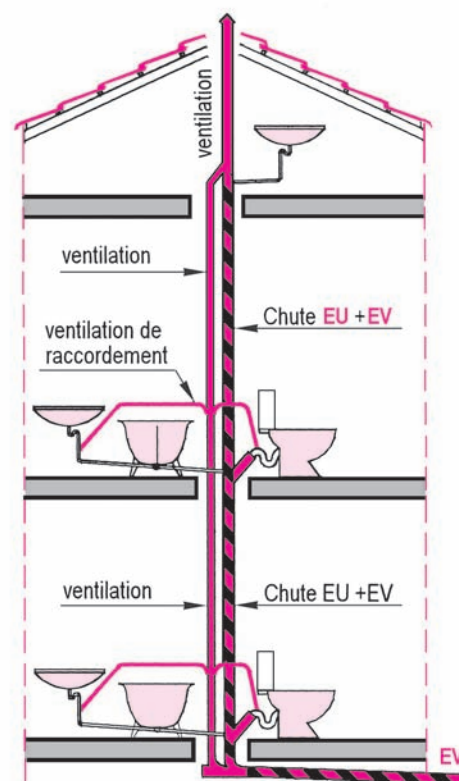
Conduites de raccordement avec ventilation secondaire
